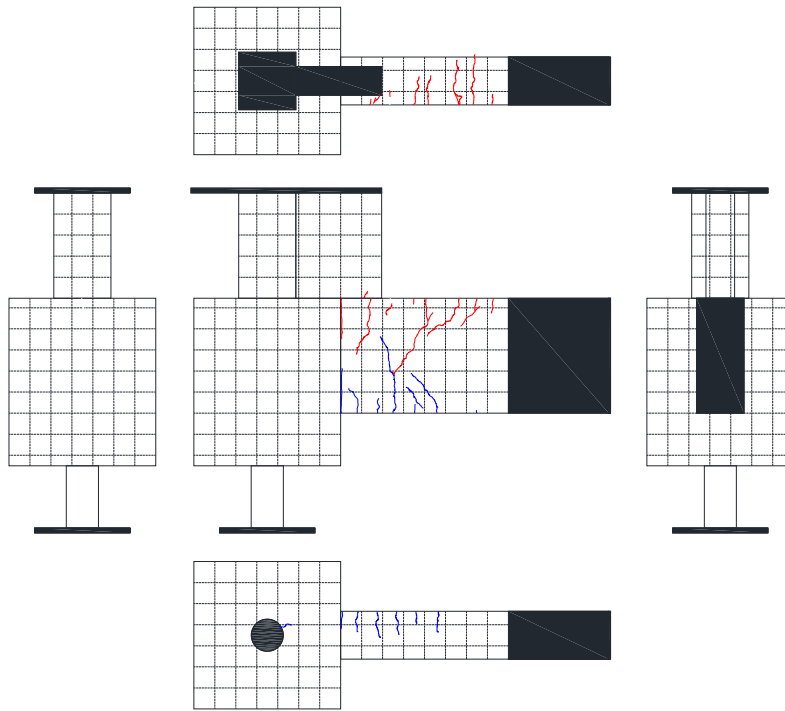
2. 3-45 試験体 DR-4 ひび割れ状況 (2Cycle)
